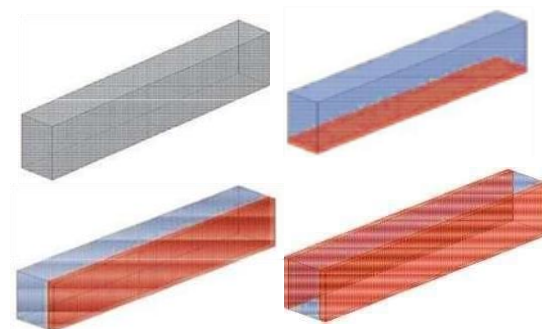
Grupos en función del refuerzo en color rojo: viga padrón; viga con refuerzo inferior; viga con refuerzo lateral y viga con doble refuerzo lateral.
